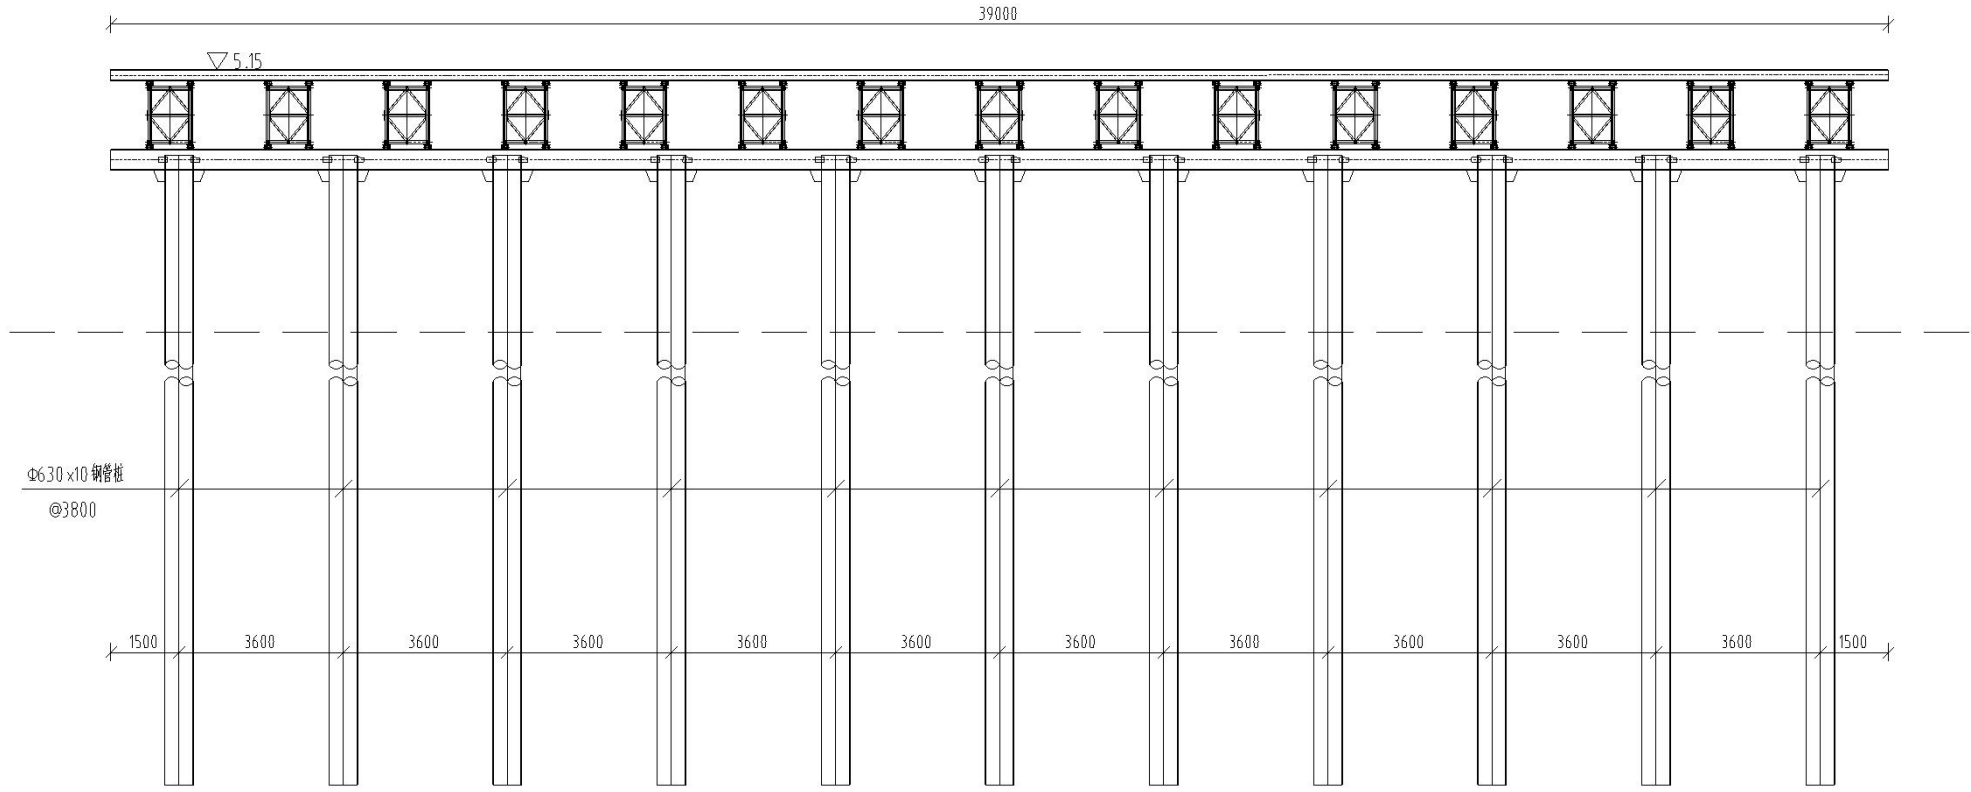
桩基施工临时平台断面图（码头）
